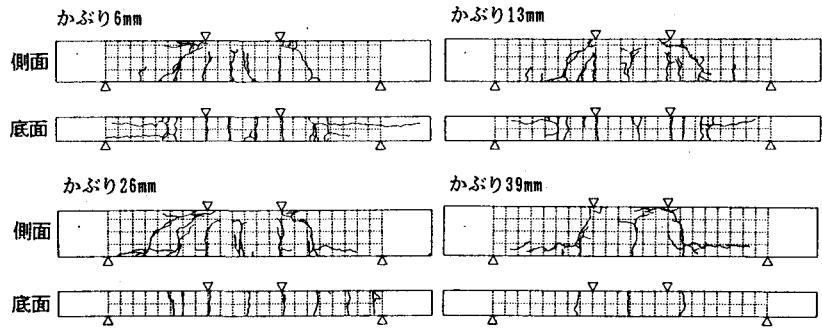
アラミド繊維を用いたはりのひび割れ発生状況
